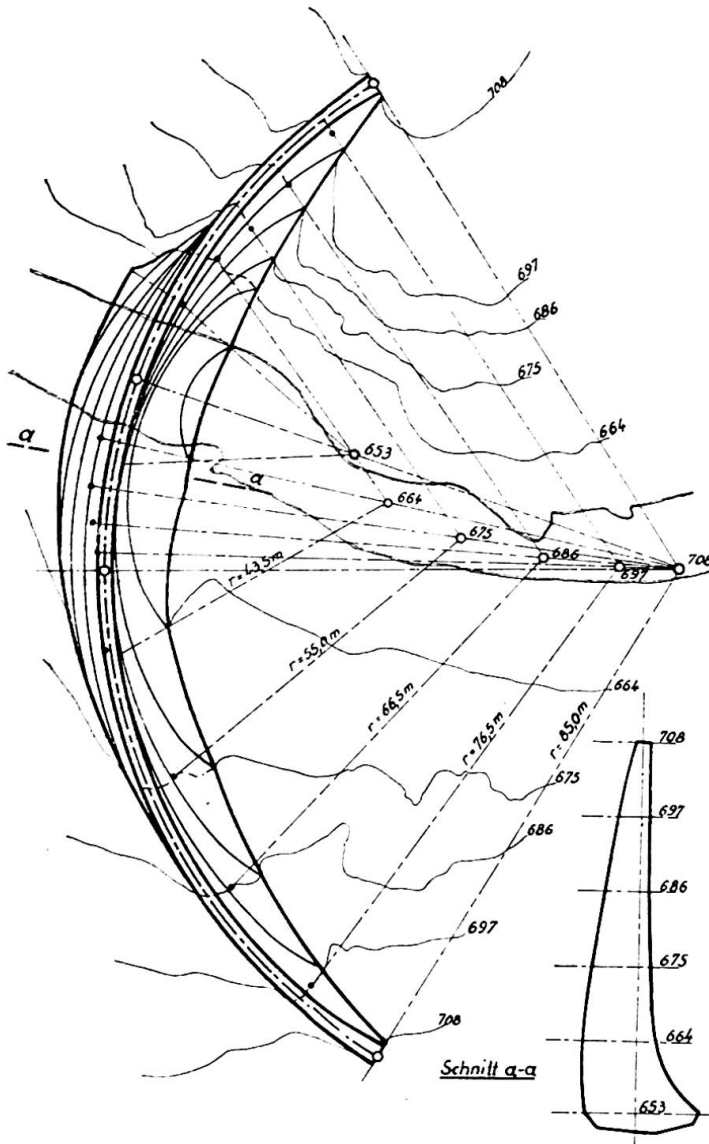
Salzasperr. Lageplan mit Talsohlenquerschnitt.
